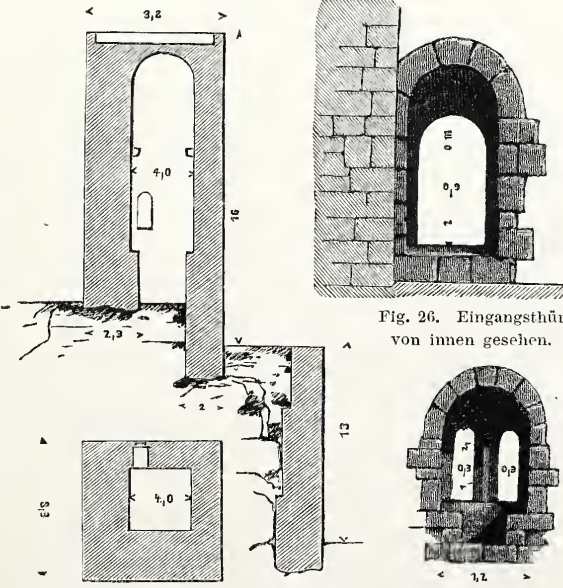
u. 25. Grundriss und Schnitt. Fig. 26. Eingangsthuir von innen gesehen. Fig. 27. Fenster.
